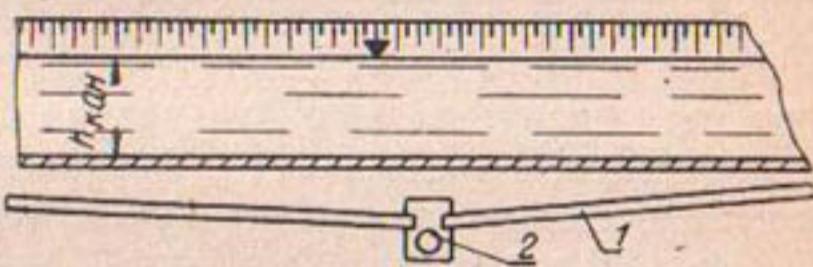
Схема примыкания продольных дрен к поперечной выводной дрени:
